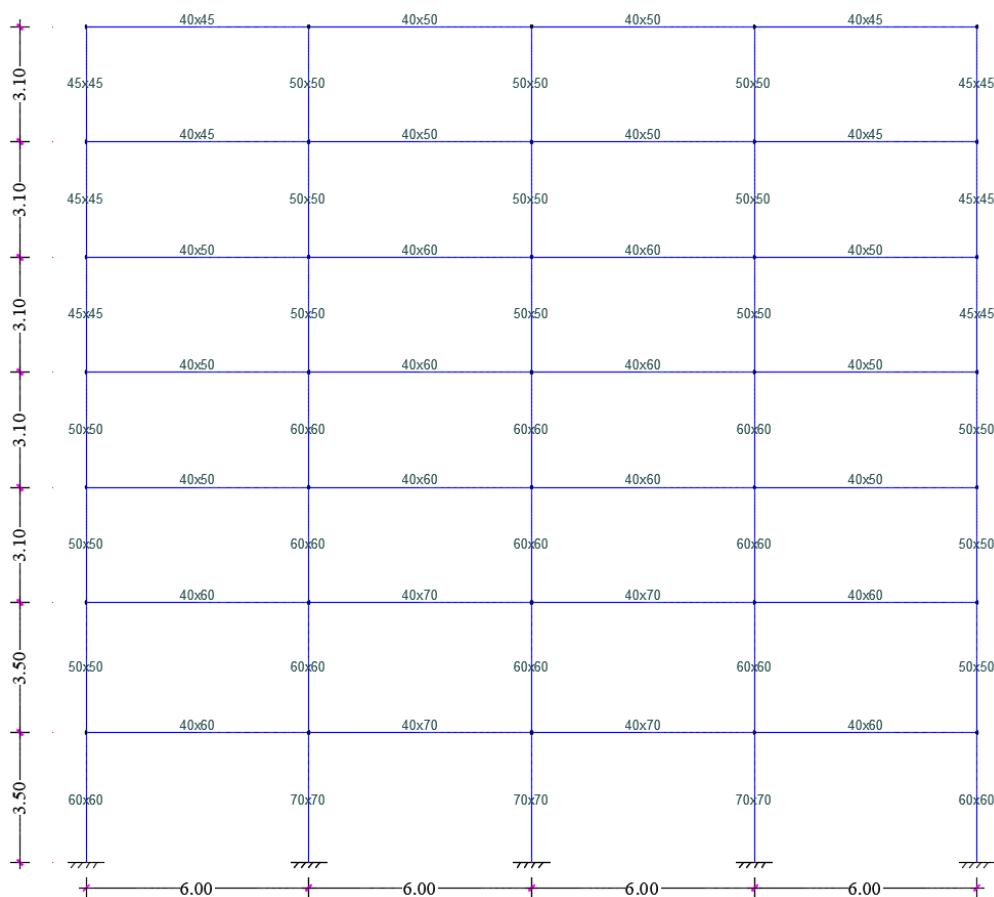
Pórtico plano de 7 pisos y 4 vanos
